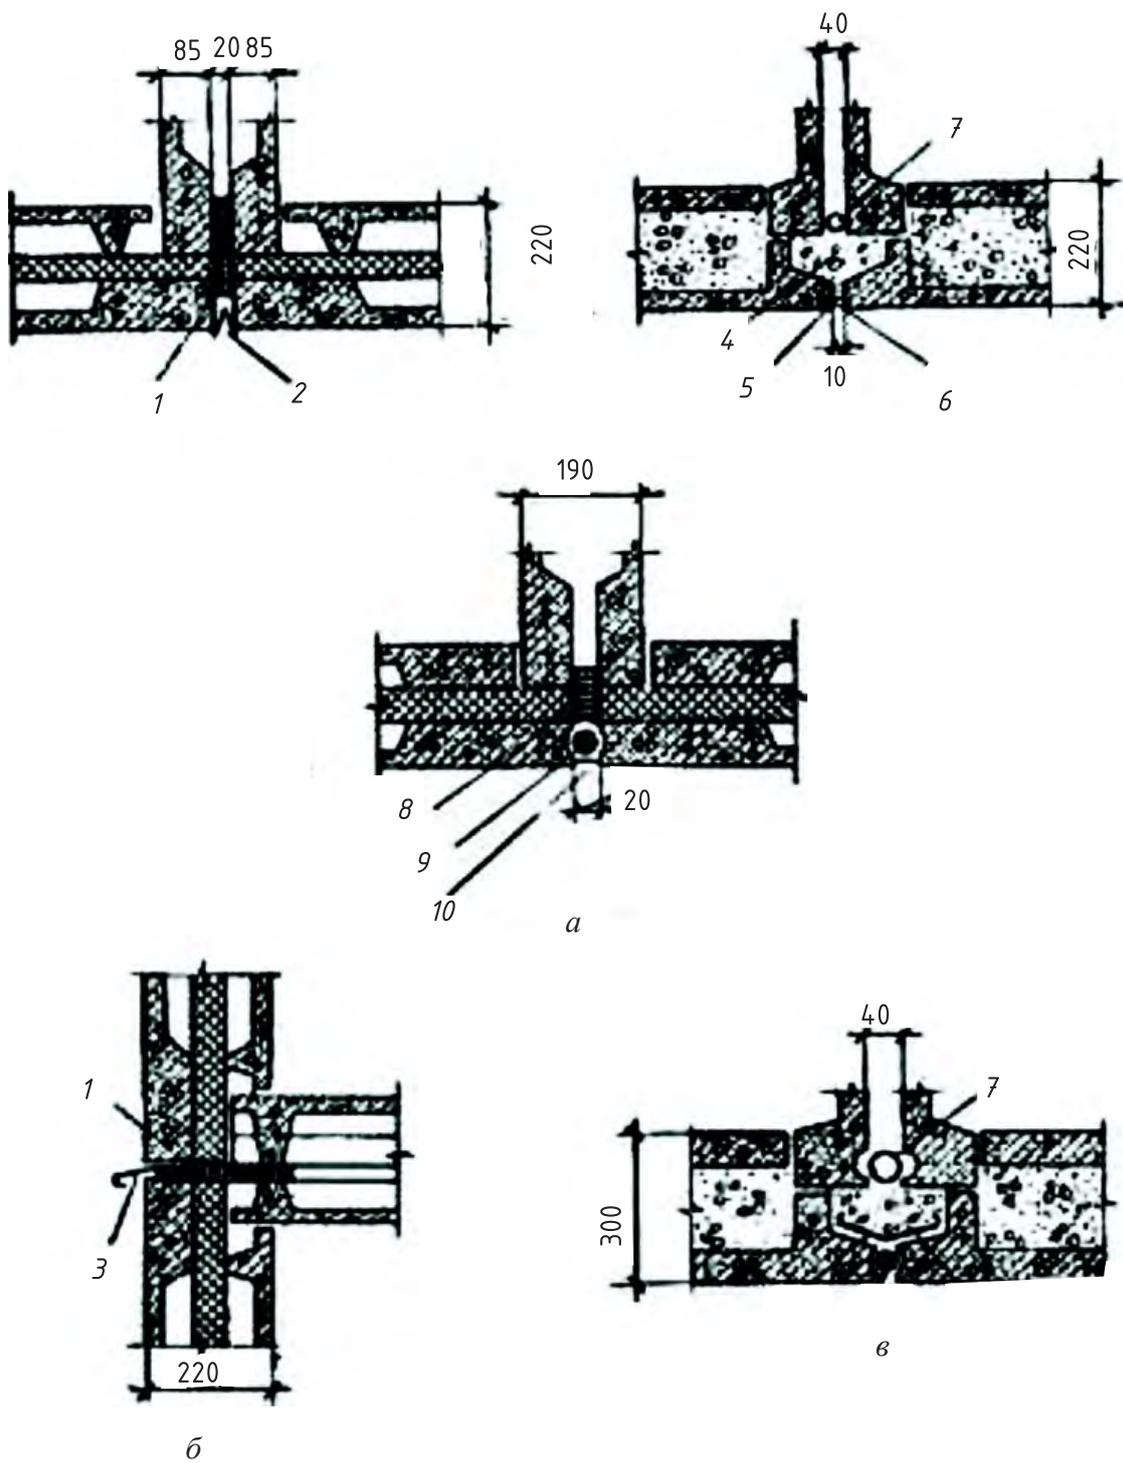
Конструкции стыков здания из сборных объемных элементов: *а* и *в* — вертикальные стыки; *б* — горизонтальный стык: 1 — уплотнитель шва; 2 — пластмассовый нащельник; 3 — пластмассовый фартук; 4 — керамзитобетон; 5 — просмоленный канат; 6 — цементный раствор; 7 — пергаминовая или резиновая трубка; 8 — полоса из поропласта; 9 — жгут из пороизола; 10 — герметизирующая паста
